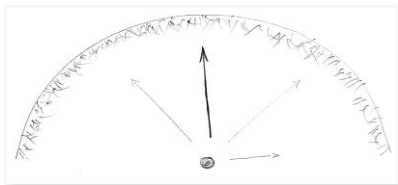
Grundriss Skizze der Espresso-Bar Bürstenwand
